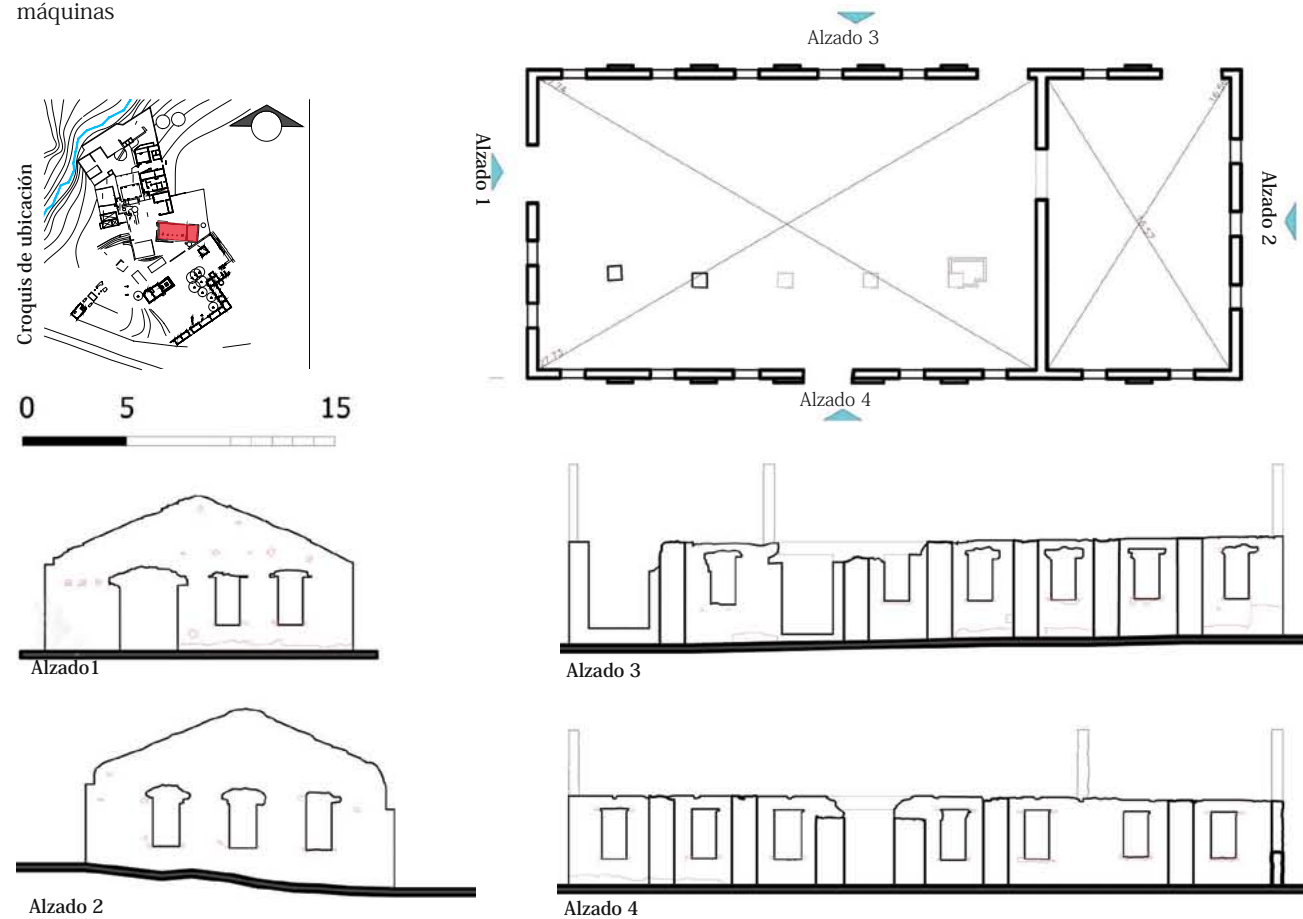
Planos del levantamiento arquitectónico del estado actual.
